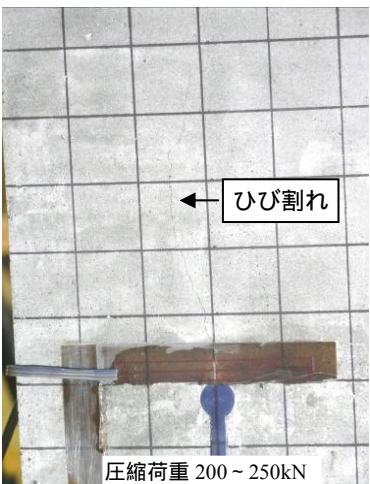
供試体 4 の載荷途中のひび割れ発生状況
